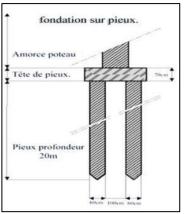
Fondation sur pieux Source: http://www.cours-genie-civil.com
